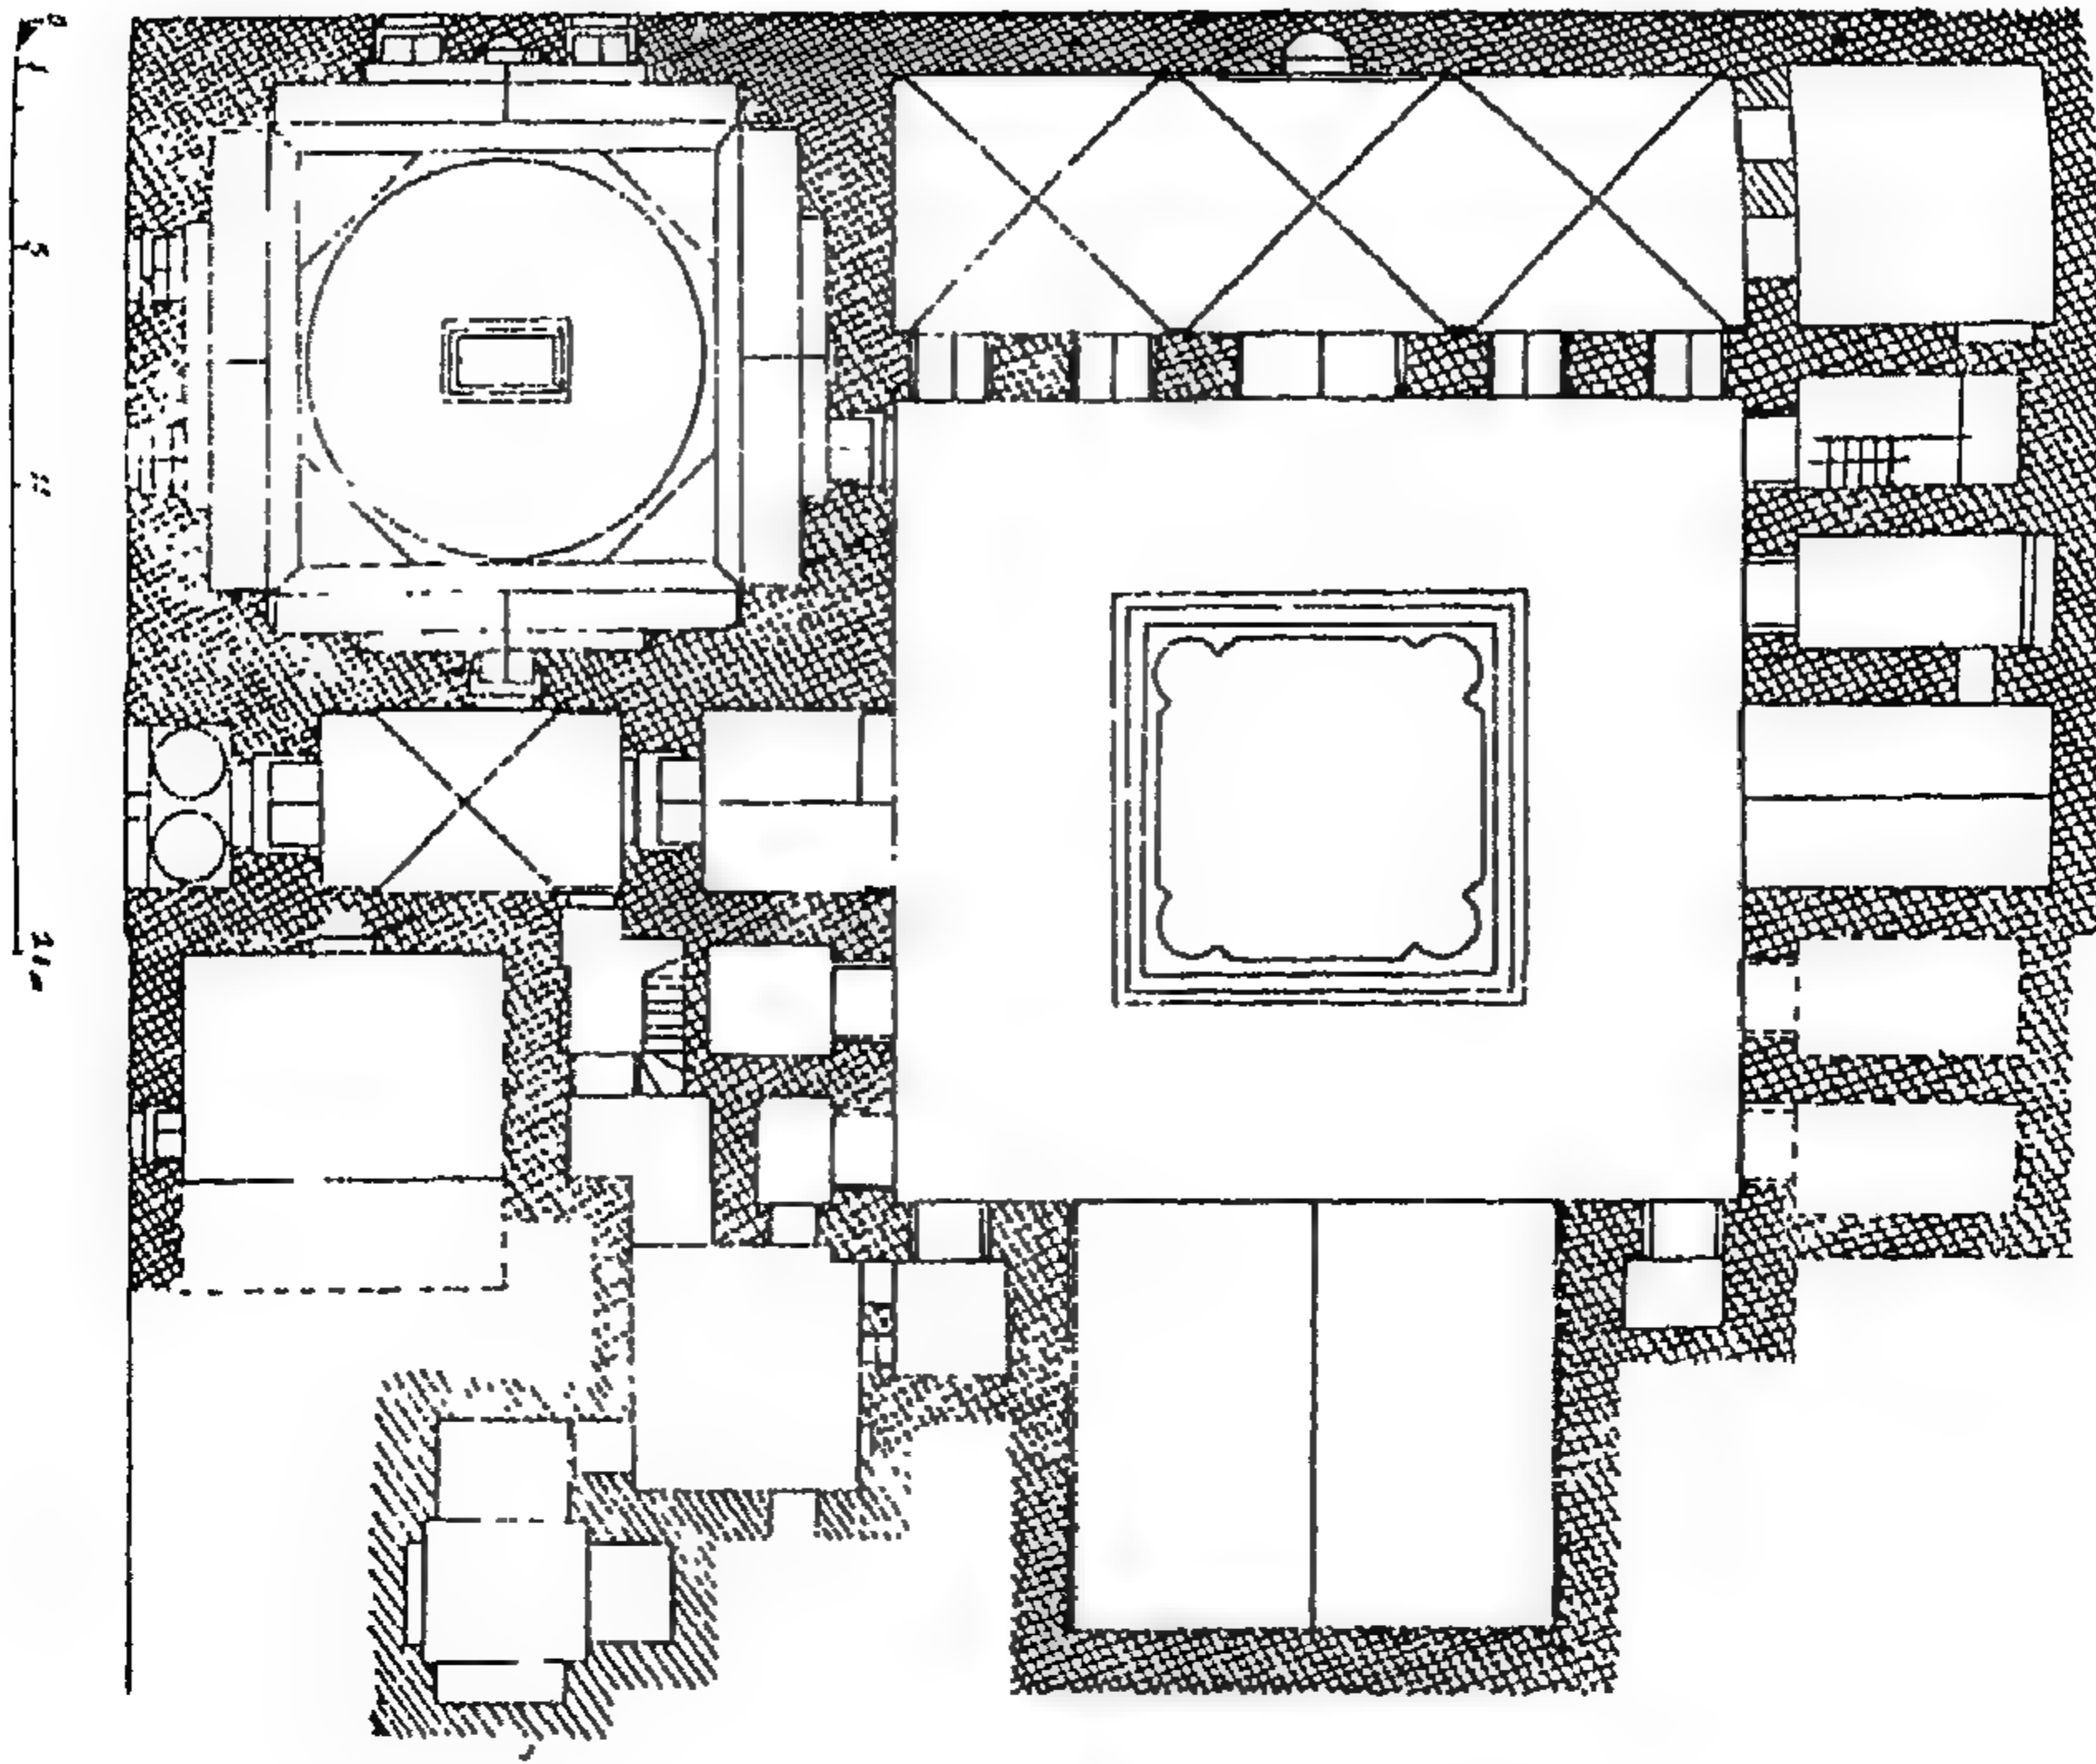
مسقط أفقي لمدرسة الفردوس في حلب (عن : كريزول) .
